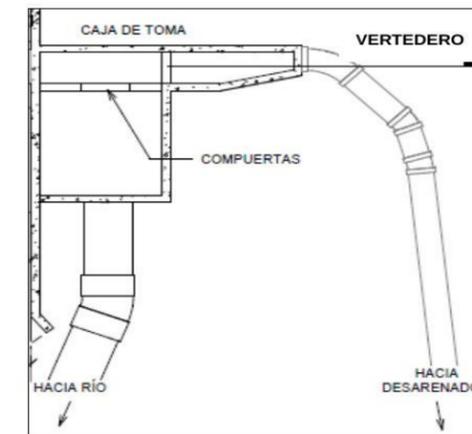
Perfil Azud, canal de entrada, cámara de carga y tubería de aducción al desarenador
